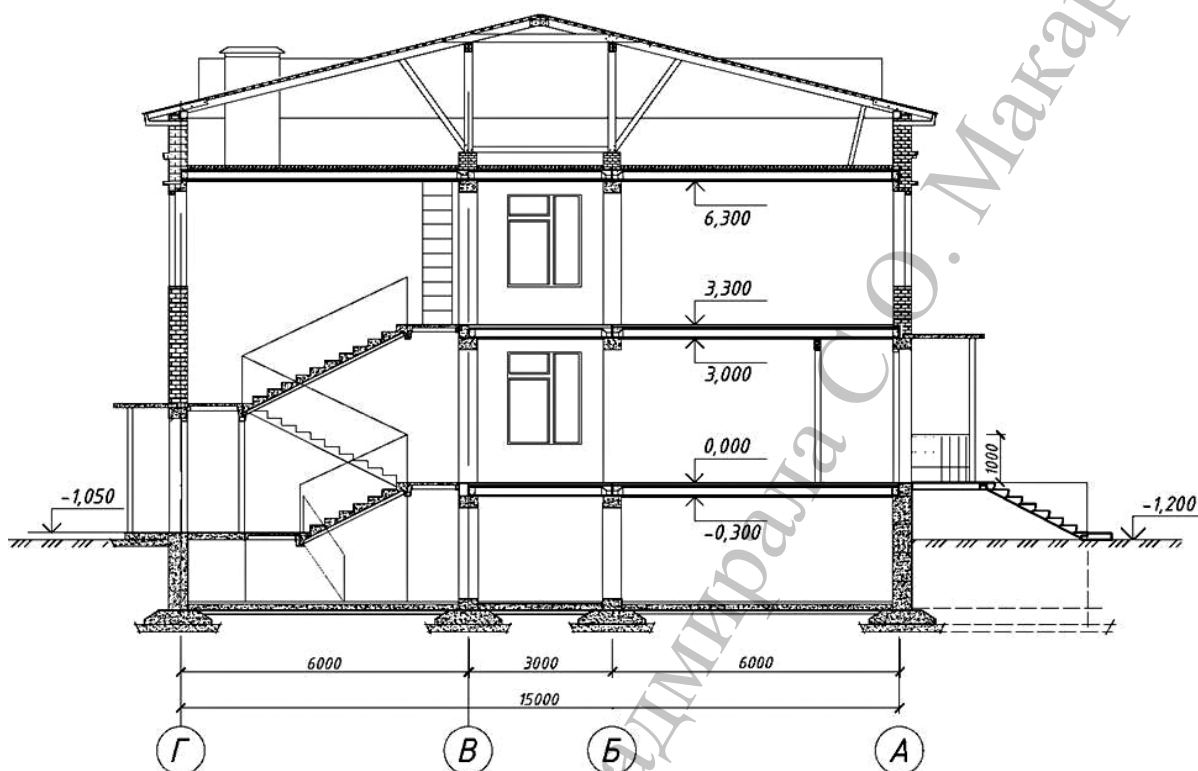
Поперечный разрез трехпролетного здания с продольными несущими стенами
